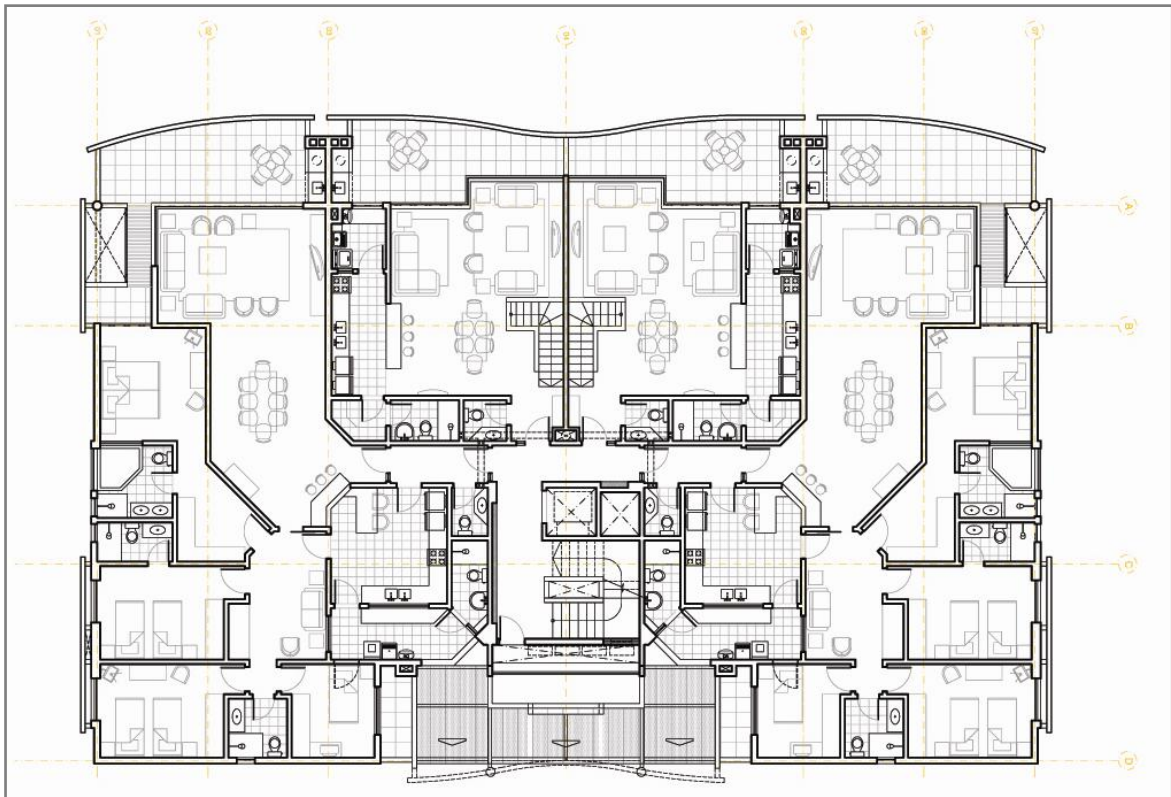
Planta baixa do pavimento tipo do bloco 02.
